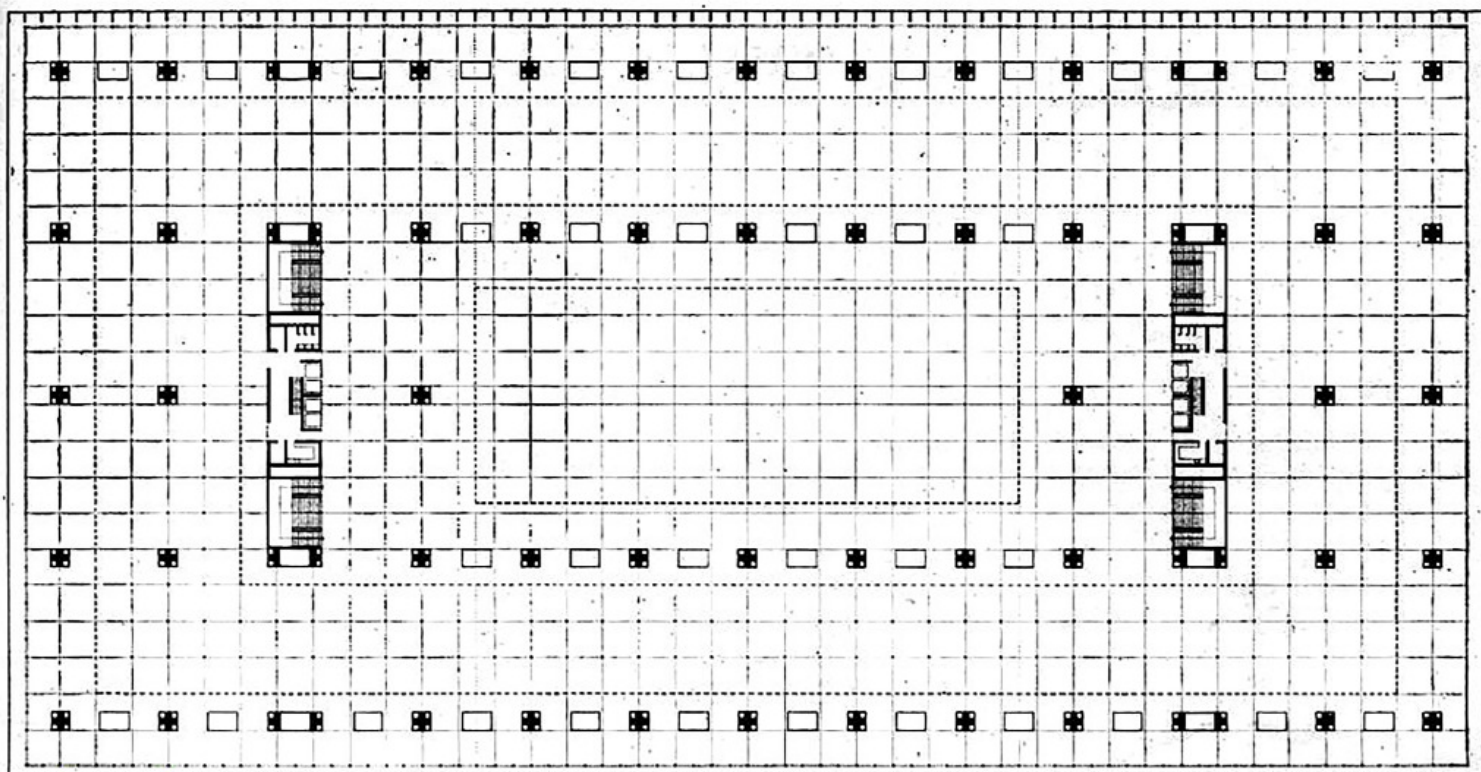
Planta del bloque tipo para el sector de enseñanza.Fuente: La Ciudad Universitaria de Tucumán (1950).
